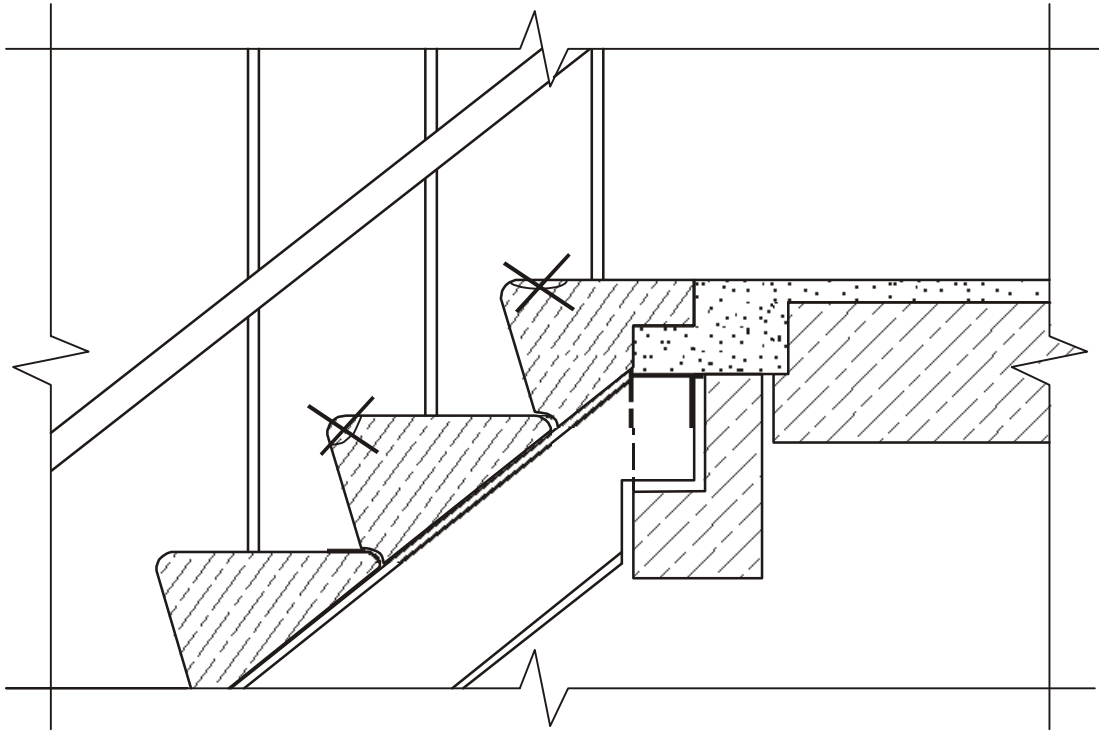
Образование сколов и разрушений железобетонных ступеней лестниц
